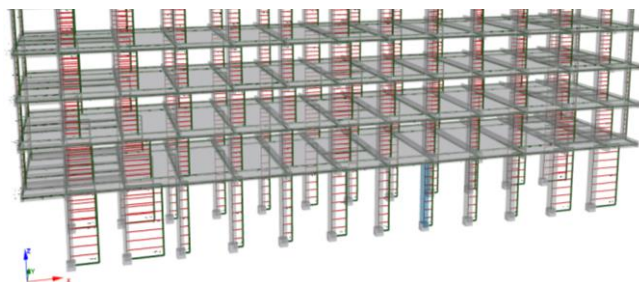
Equilíbrio de esforço transverso para um carregamento horizontal aplicado à estrutura, com a adição das faixas de laje, na direção longitudinal no Seismostruct.
